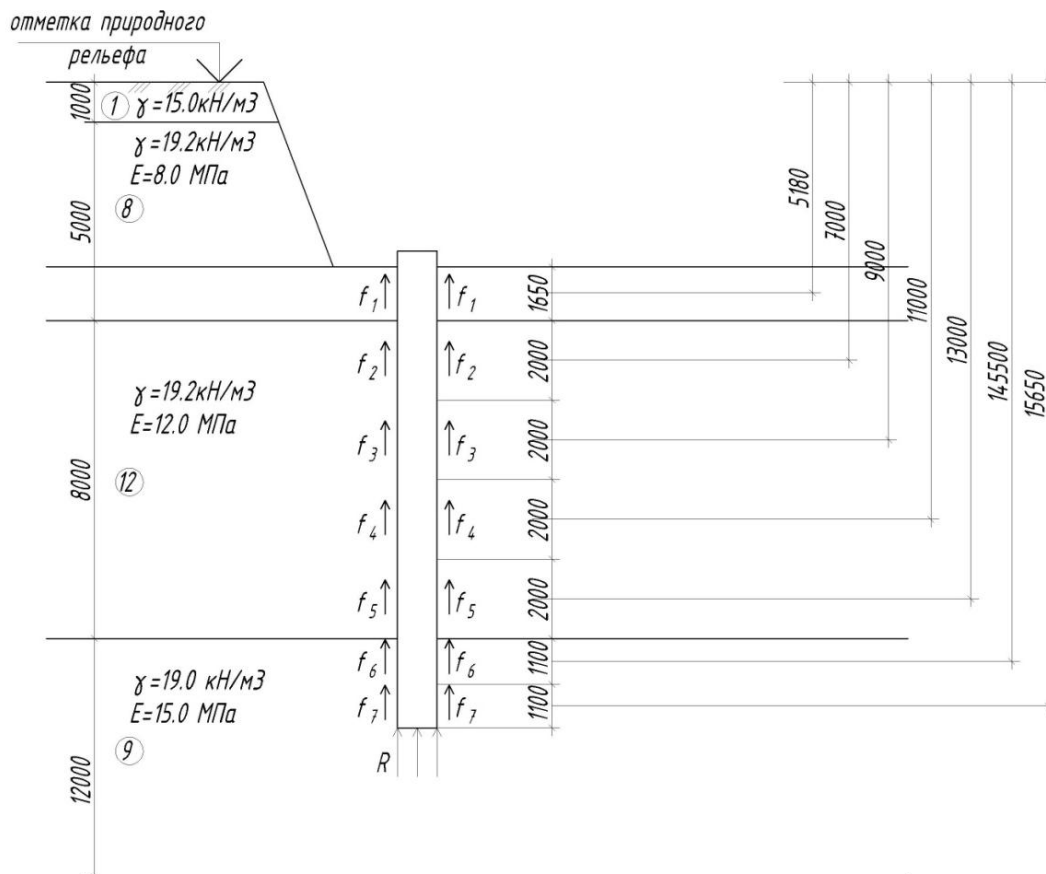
Разрез грунтовой толщи по буронабивной свае
